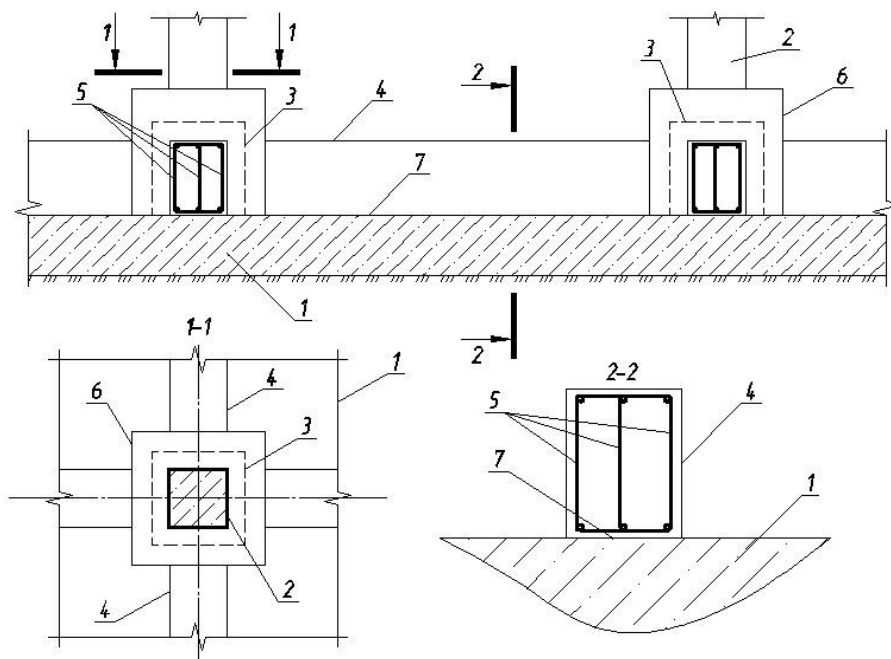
Улаштування залізобетонних балок по лініях колон:
